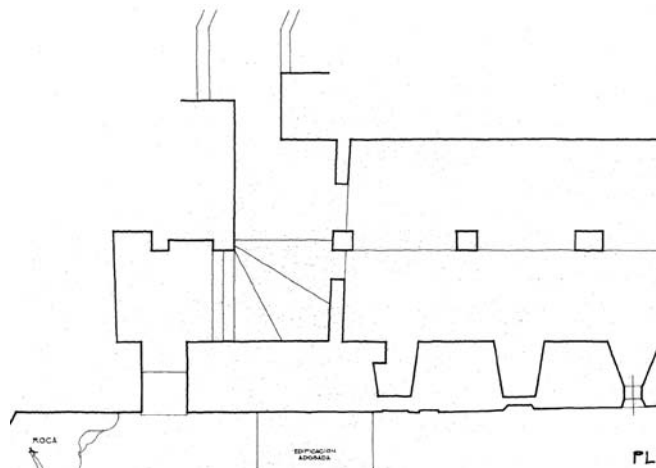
1979. Oscurico. Estado Actual. Planta de Sótano. Pons
